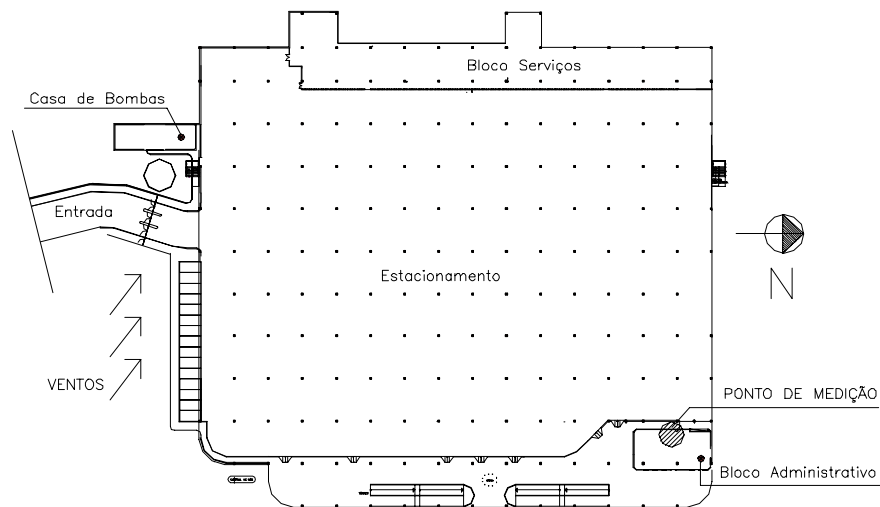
Planta baixa do estacionamento aberto (Sem escala)
